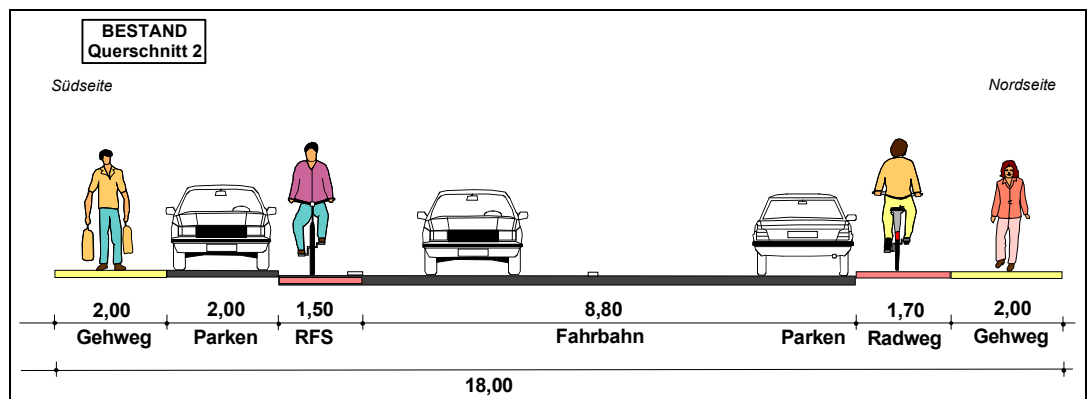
Elsässer Straße –Bestand Abschnitt 2 (Q 2)
